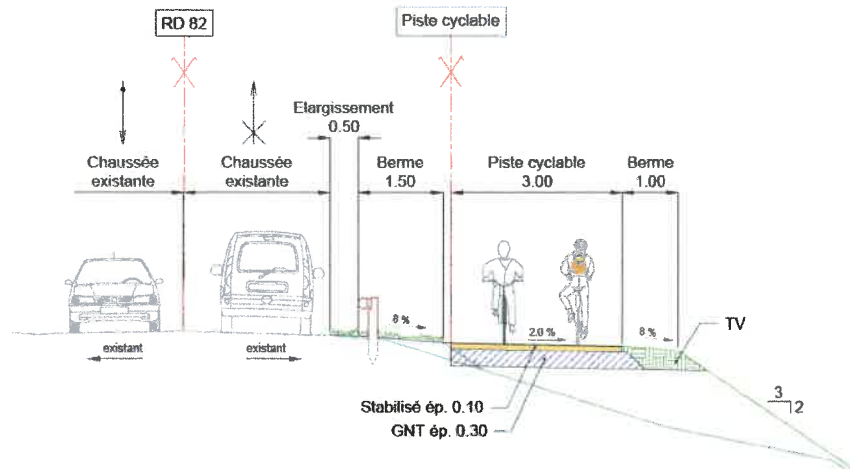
Profil en travers type de l'aménagement de la voie verte
